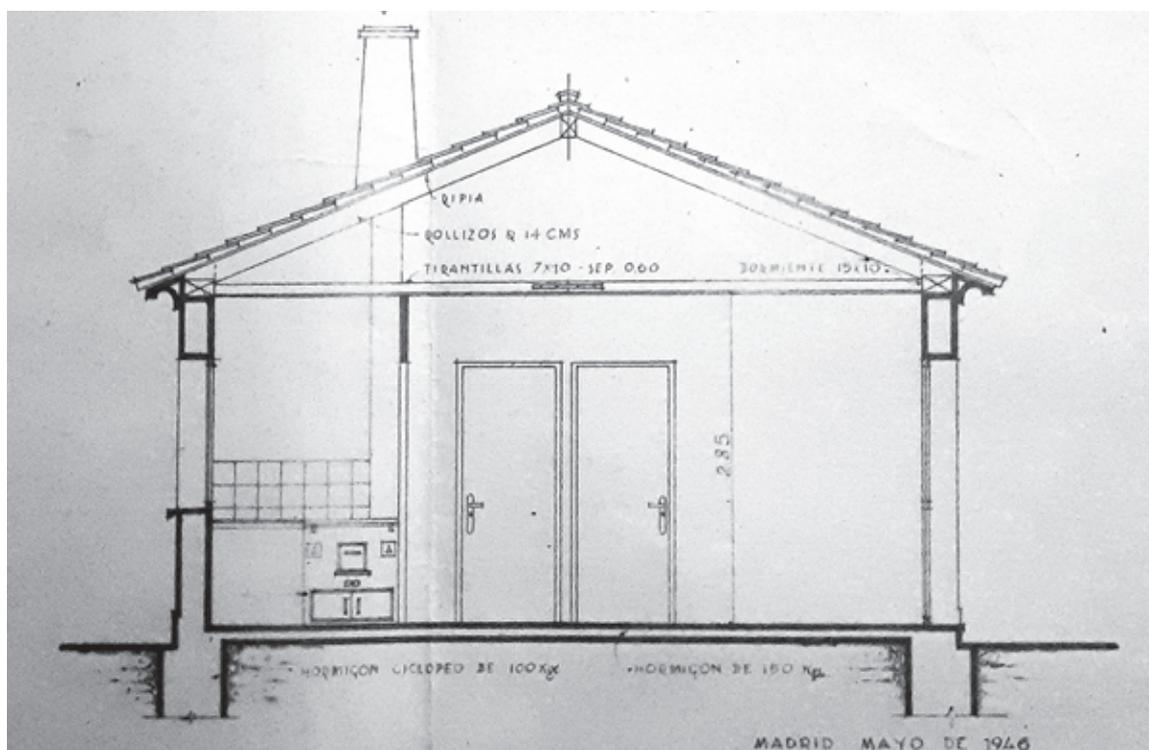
Detalle del plano de vivienda tipo F (sección), perteneciente al Proyecto de 164 viviendas ultrabarratas protegidas y un dispensario en la Barriada Juan Yagüe de Burgos. Fuente: ACFomJCyL, exp. 1660
